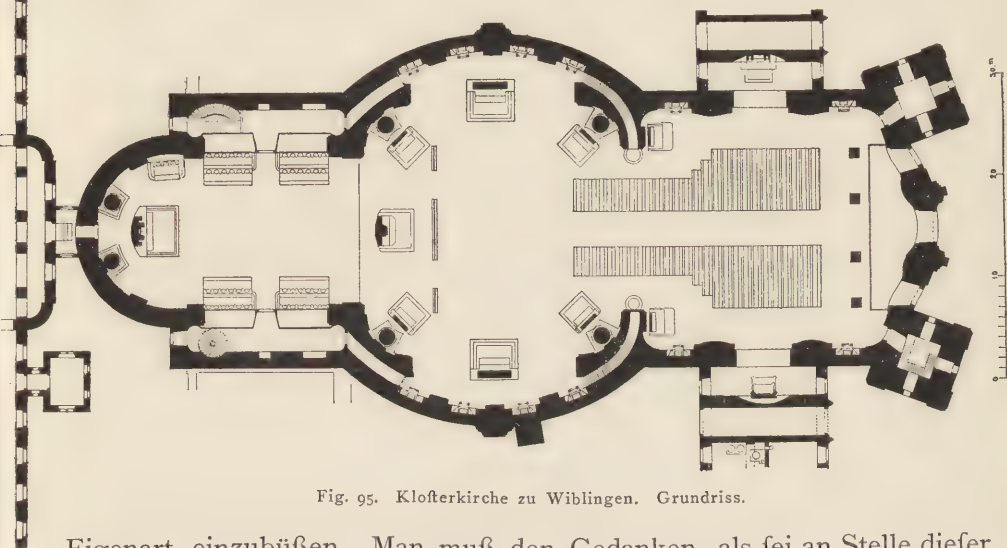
Klosterkirche zu Wiblingen. Grundriss.
